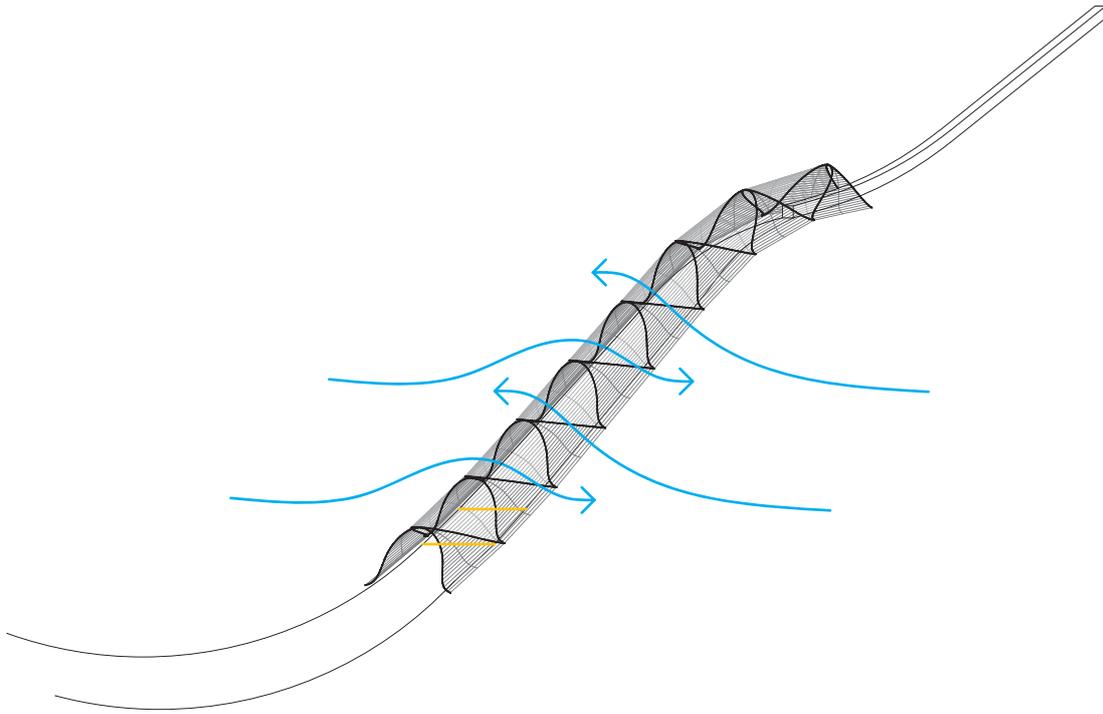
3D-Darstellung geschlossene Schutzhülle o. M.
